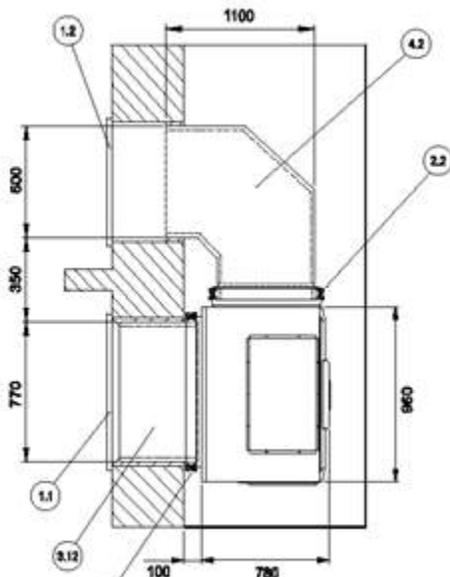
Vista dall'alto - installazione ad angolo diretta con strisce isolanti
